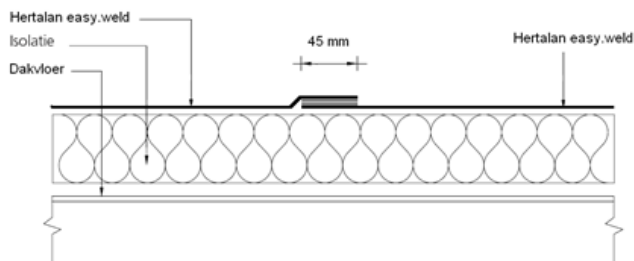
Langse overlapverbinding HERTALAN EASY WELD
